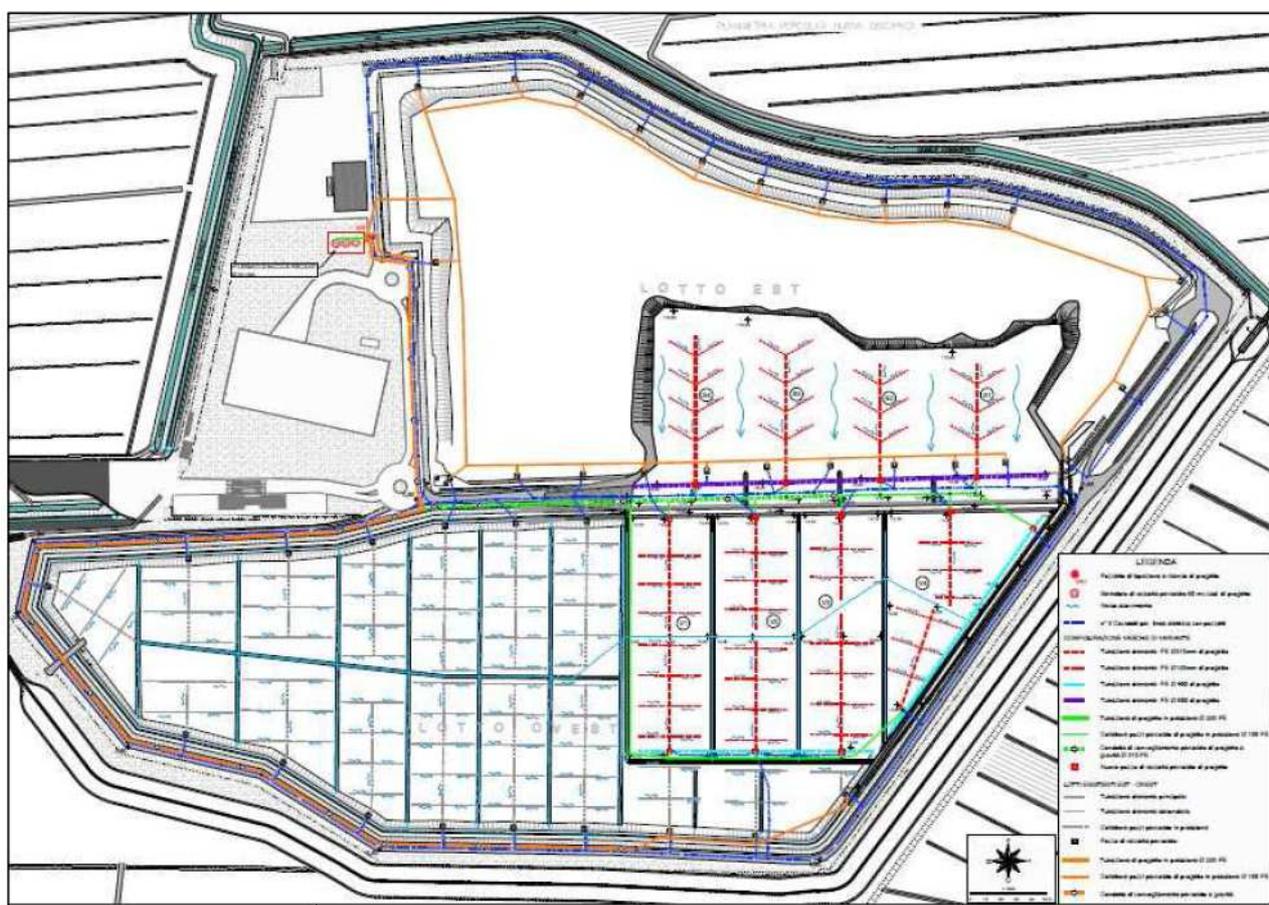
Planimetria rete di raccolta percolato (Fonte: Tavola n. 6)
